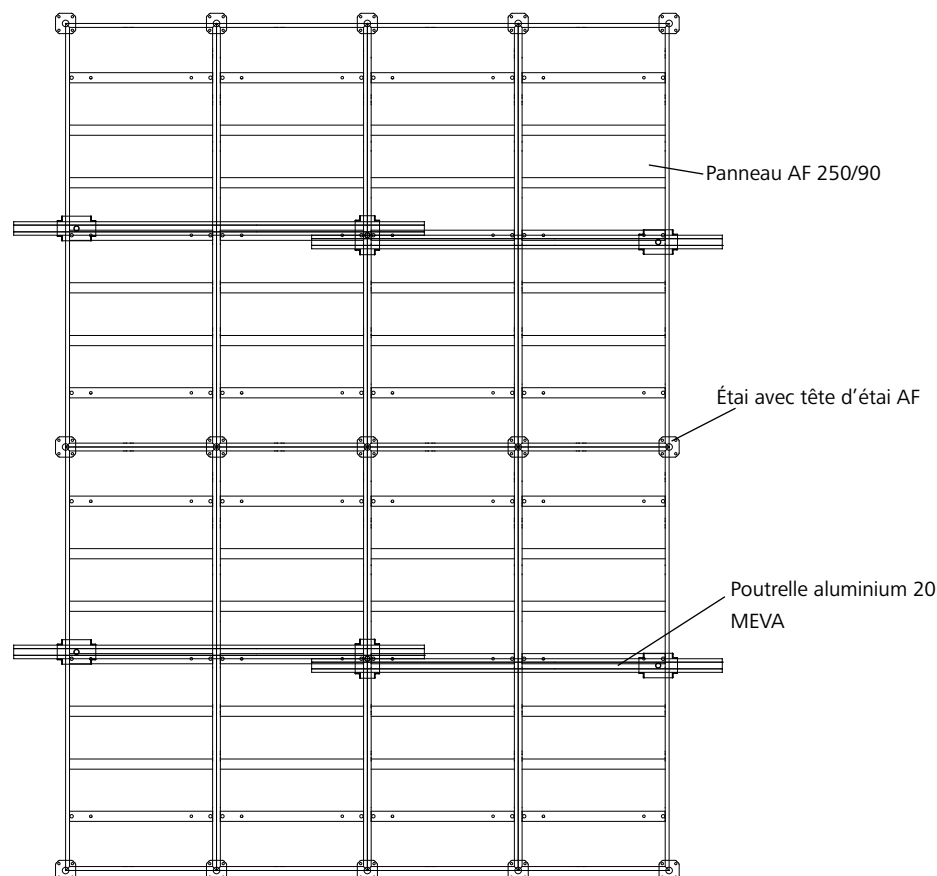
Poutrelle aluminium 20 MEVA utilisée comme poutre à une seule travée
